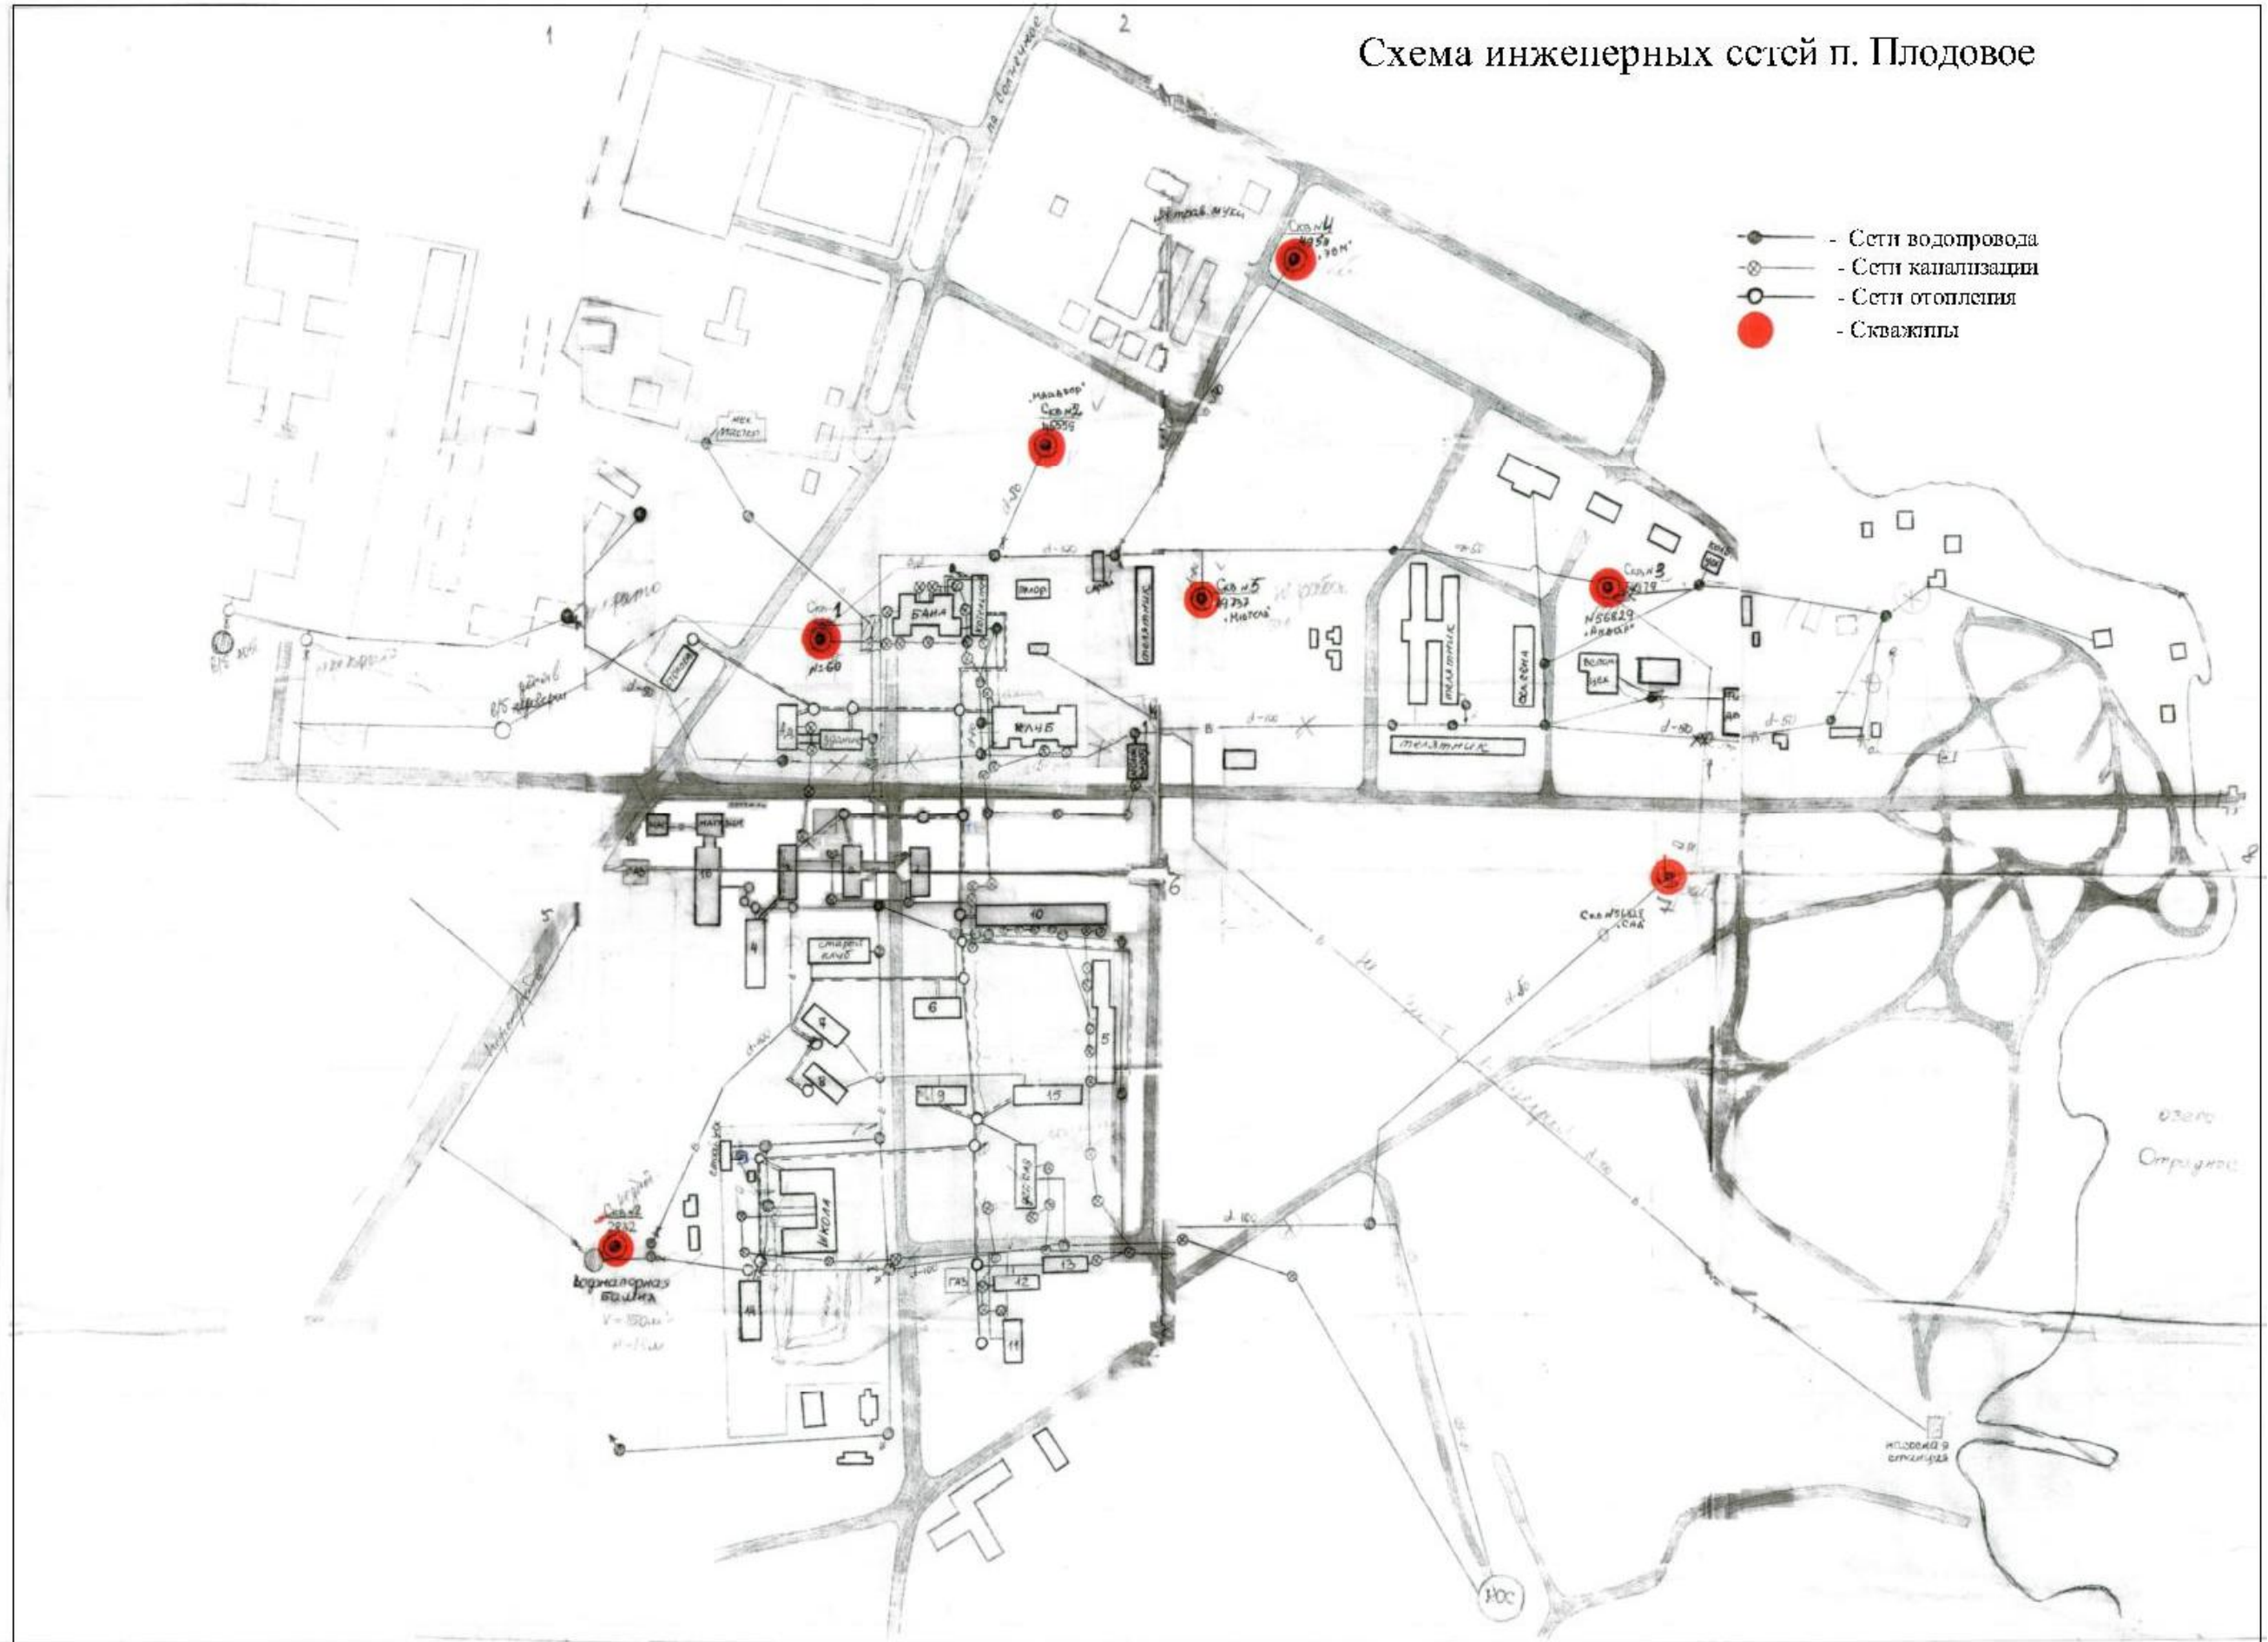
Схема водоснабжения и канализации с расположением скважин п. Плодовое
